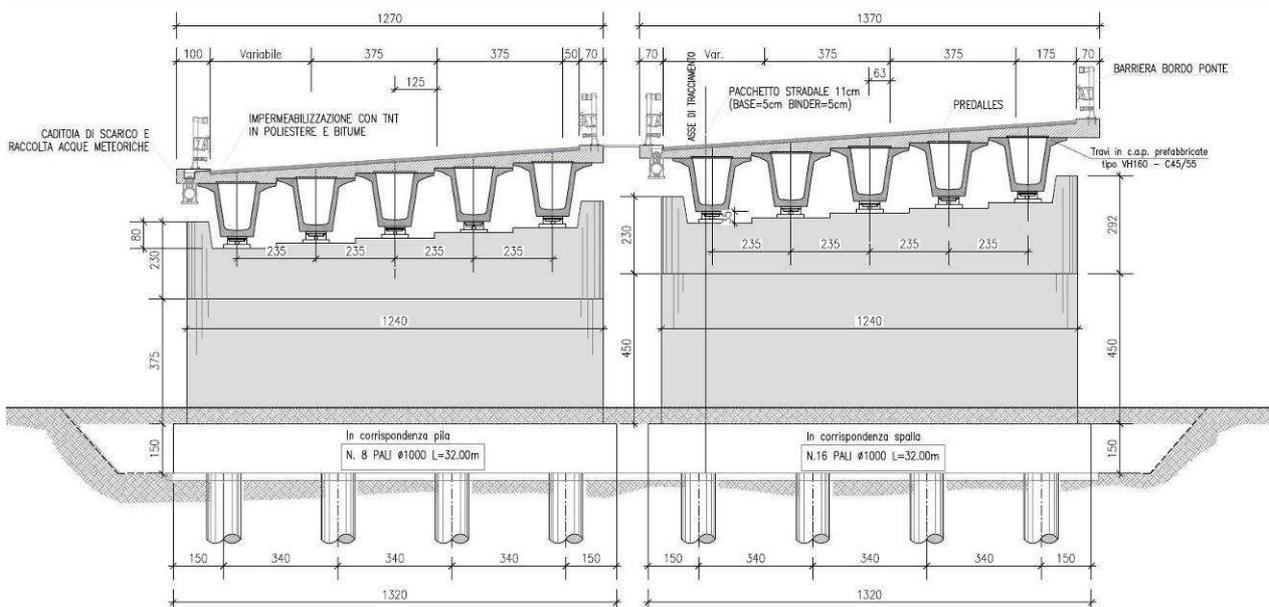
SEZIONE TIPO CAMPATA IN C.A.P. VIADOTTO VIA FERRARONI (ESTRATTO DALL'ELABORATO T00VI02STRDI01A)
